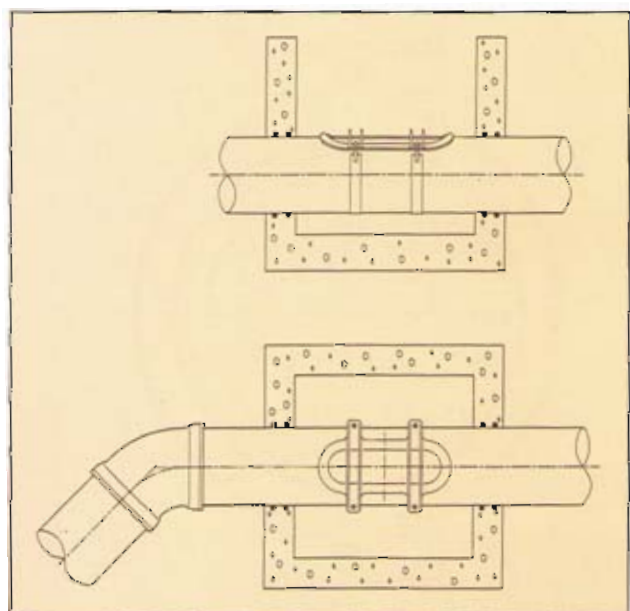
Revisionschacht mit Rohrreinigungsdeckel
